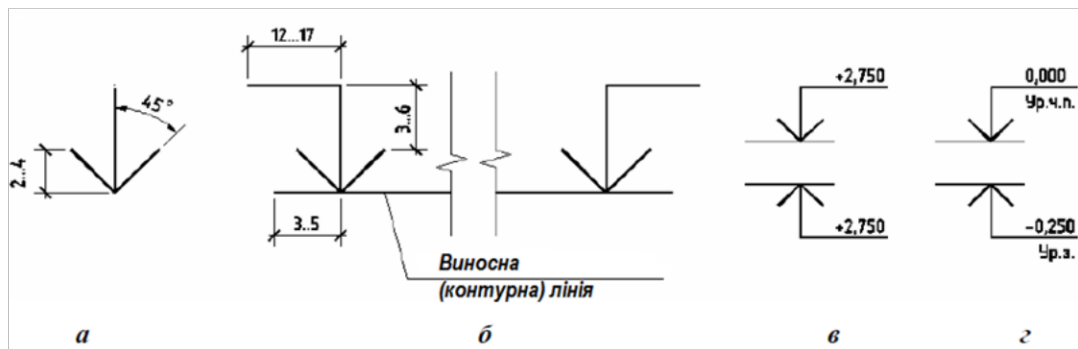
Нанесення висотних відміток на кресленнях фасадів, розрізах і перетинах:
